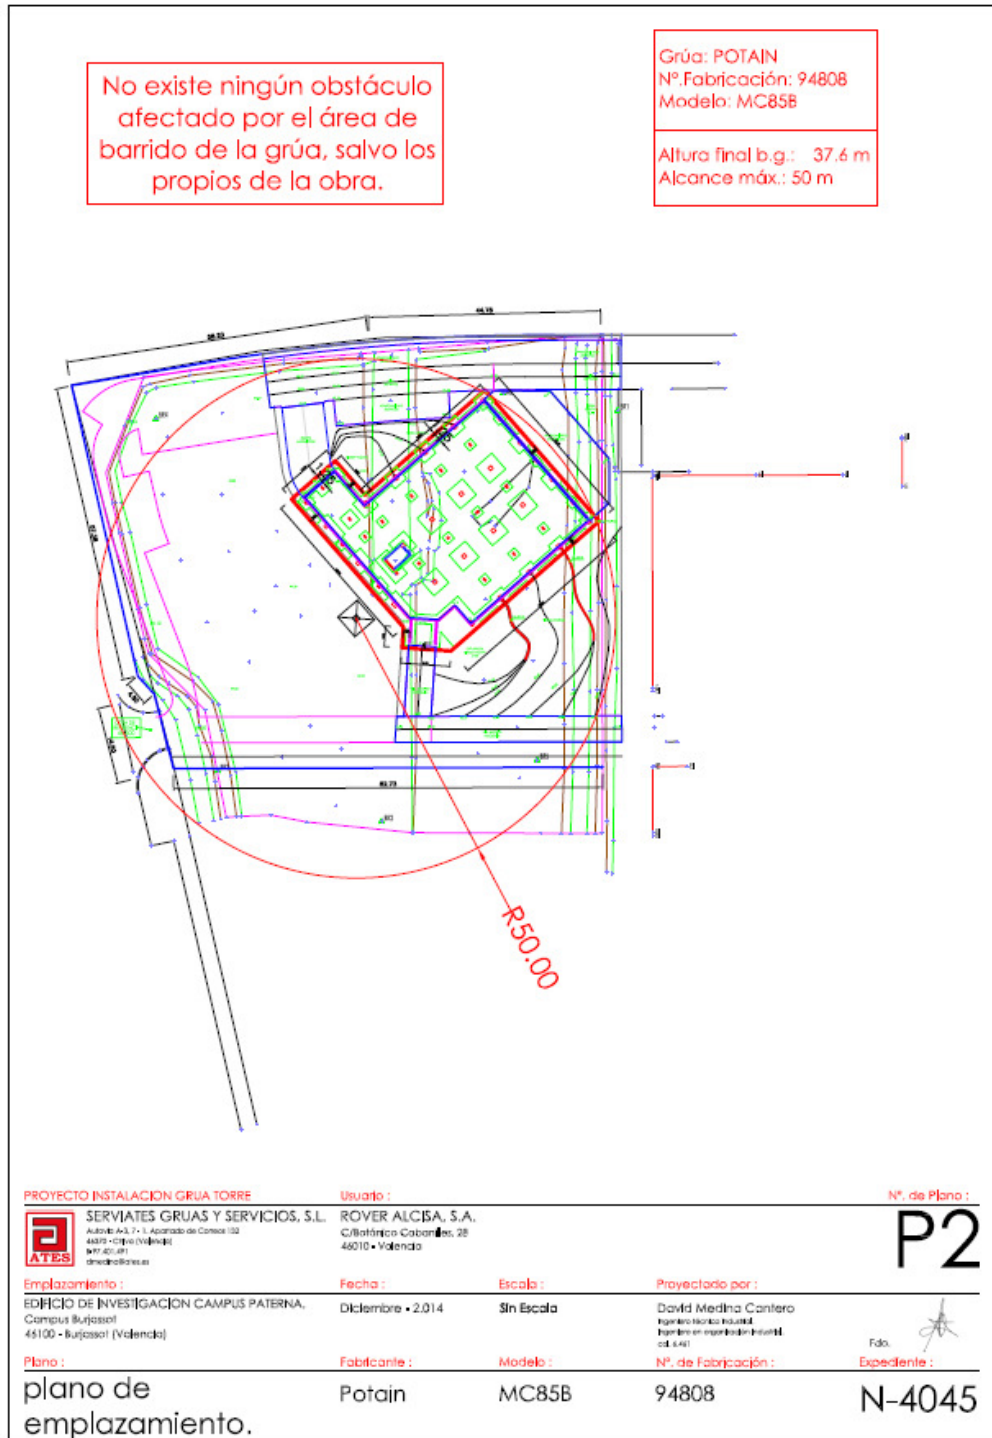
Proyecto de instalación de Grúa Torre. Plano de Emplazamiento. Autor D. David Medina Cantero. Ingeniero Técnico Industrial. Diciembre 2014.
